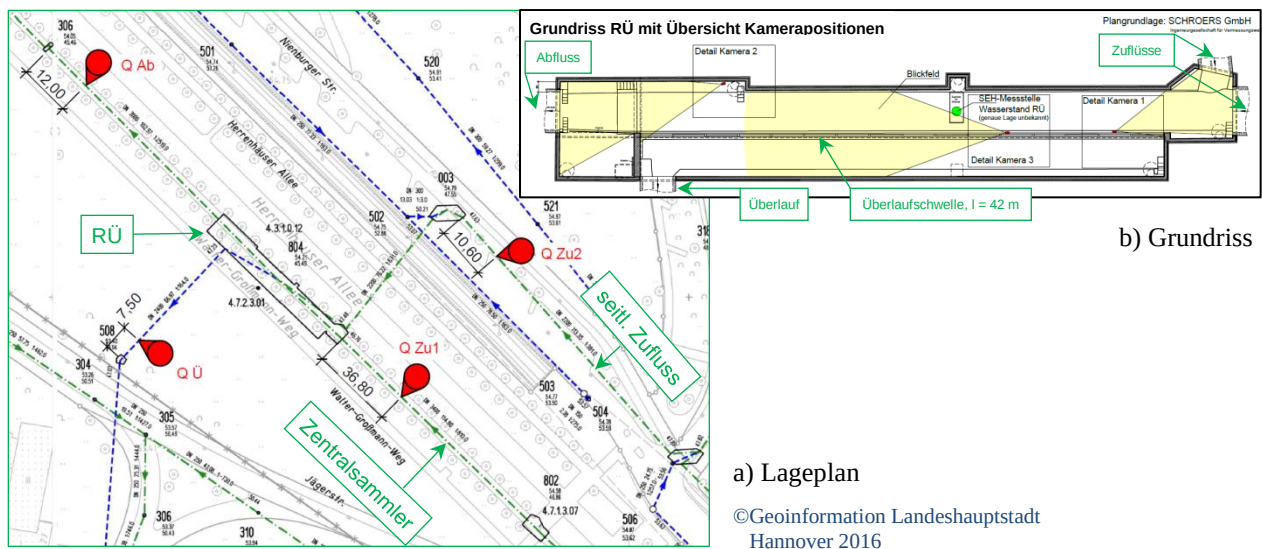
a) Lageplan temporäre Durchflussmessstellen und b) Grundriss RÜ mit Videokameras
